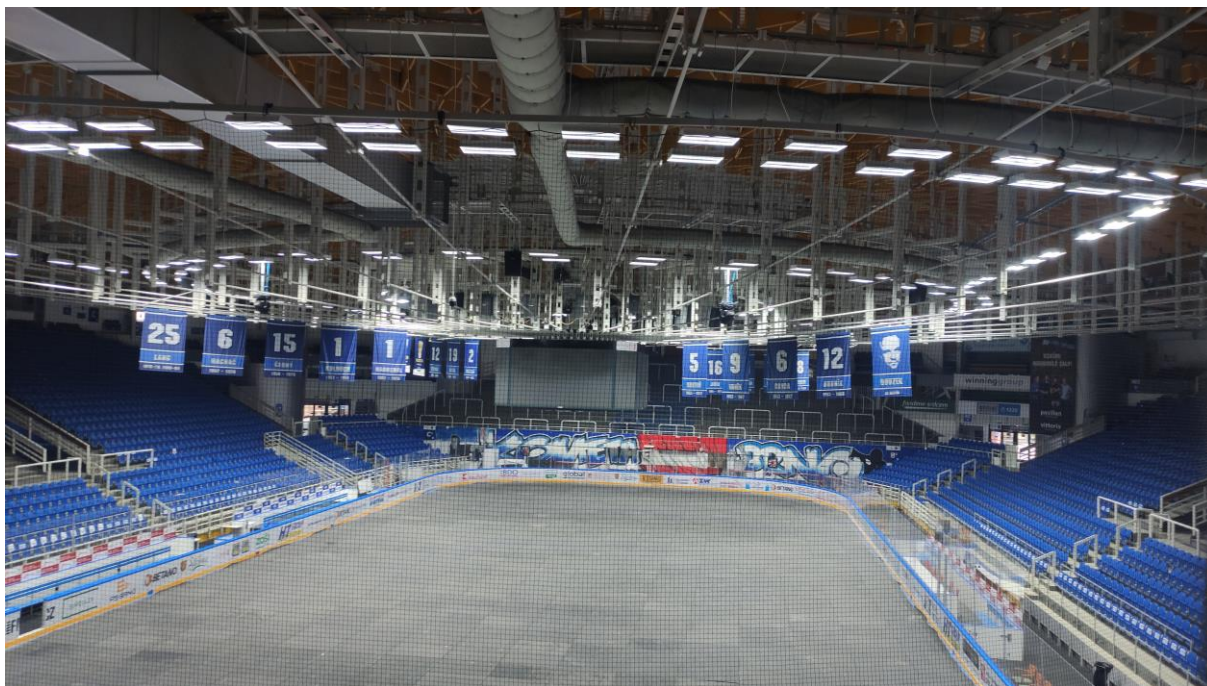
Celkový pohled na nosnou lanovou konstrukci z interieru směrem ke středu
